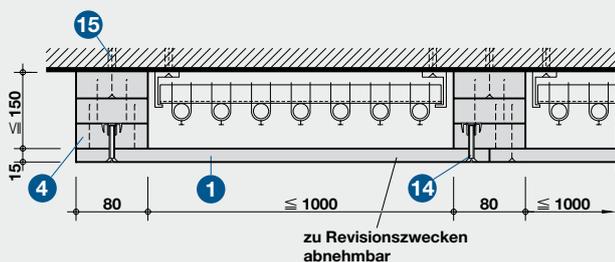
Detail K – Anschlussdetails für ein-, zwei- und dreiseitige Ausführung
